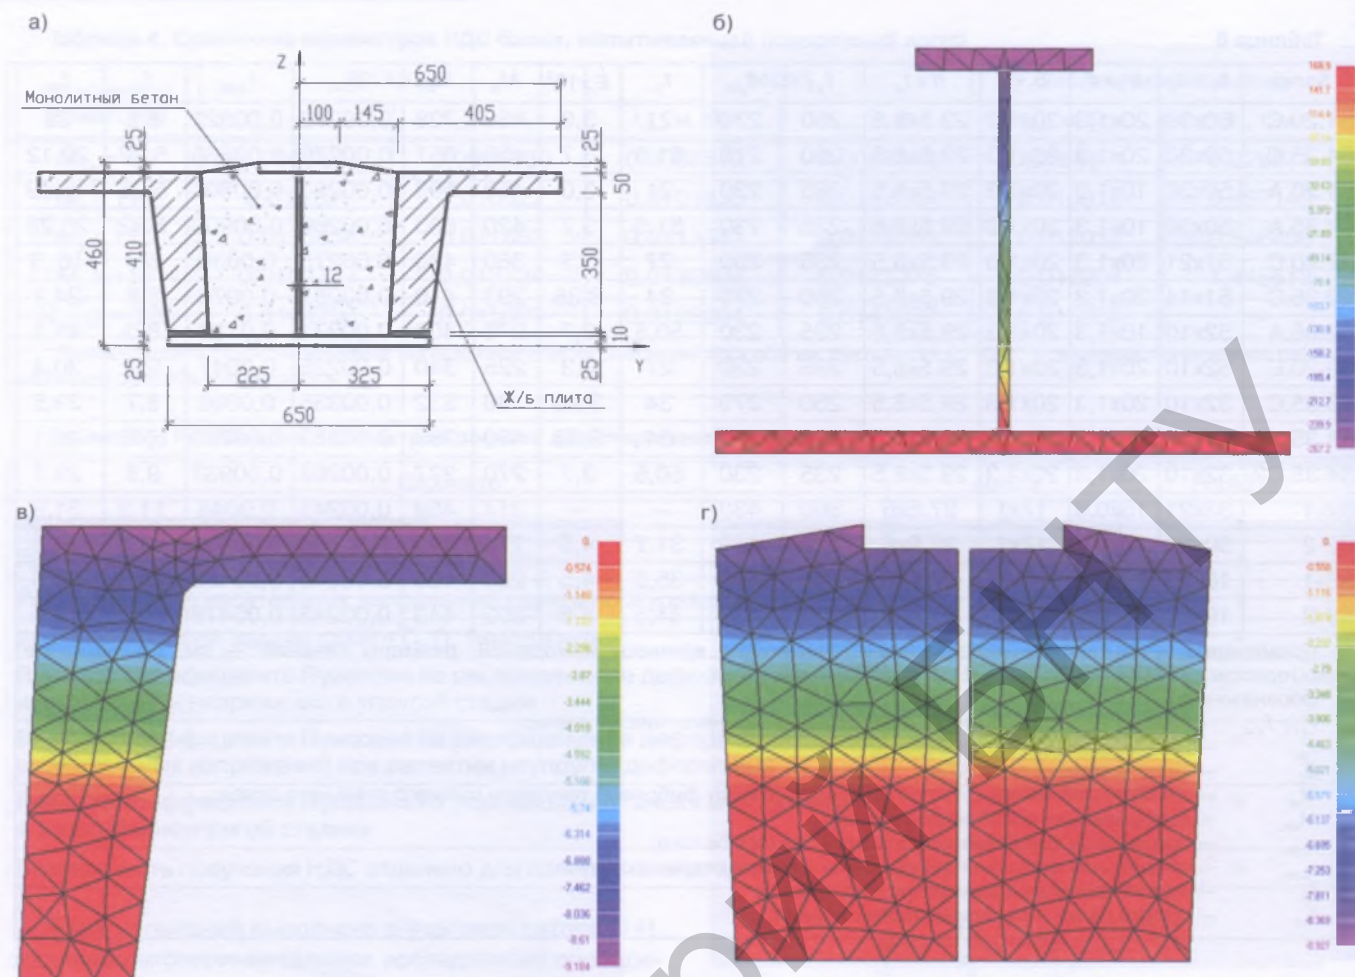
Поперечное сечение сталежелезобетонной балки перекрытия № 1 (а) и распределение нормальных напряжений σ_x в стальной части (б), бетоне плиты (в) и монолитном бетоне (г)
